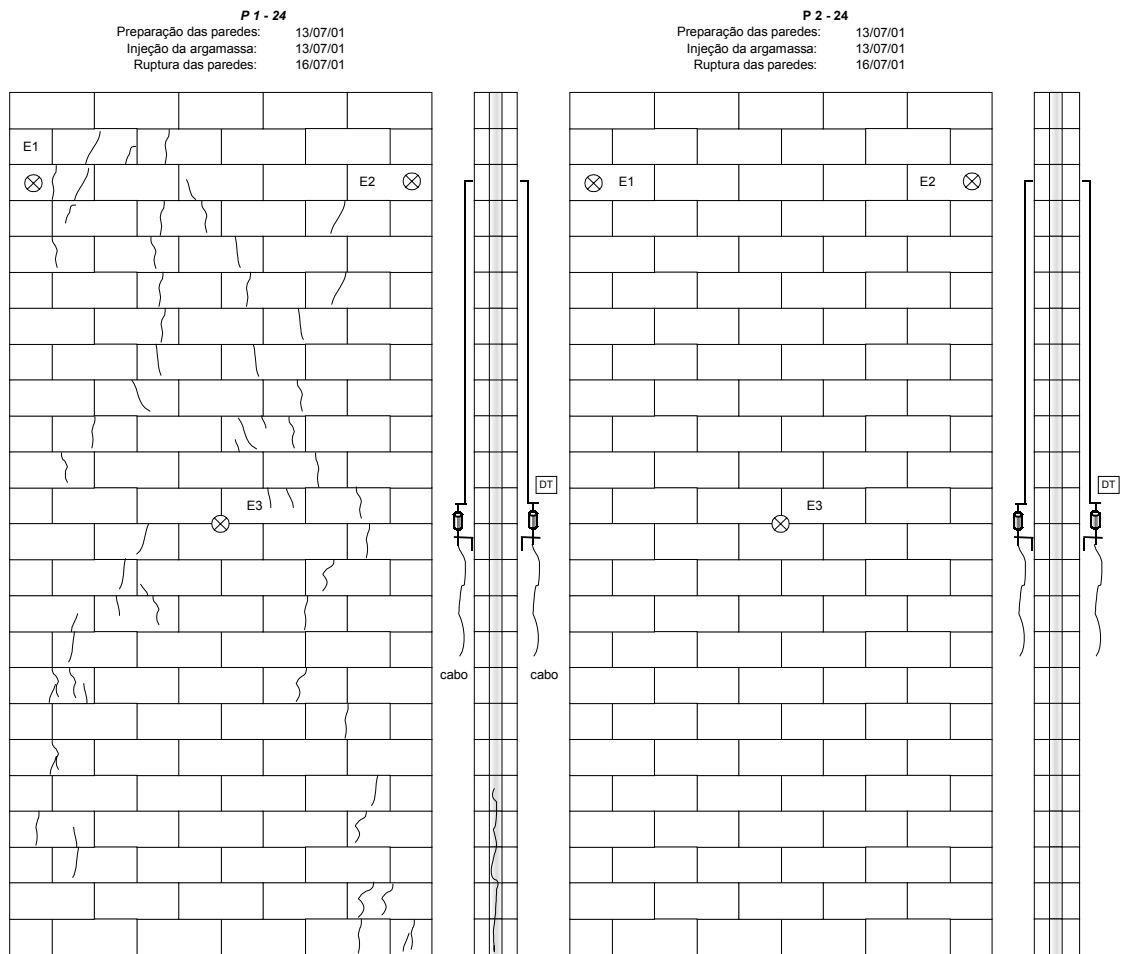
Mapa de fissuração das paredes com 24 fiadas – P1 e P2 - não se conseguiu registrar as fissuras da parede P2
